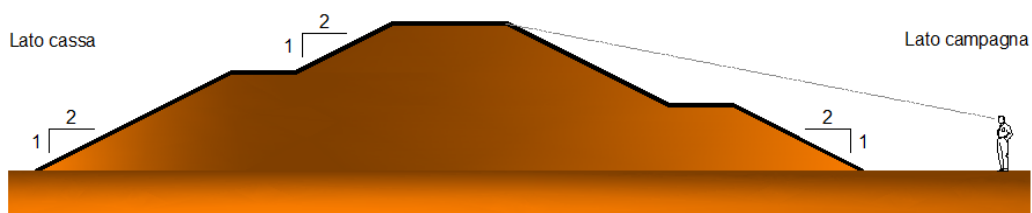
SEZIONE TIPO DEL NUOVO RILEVATO ARGINALE
